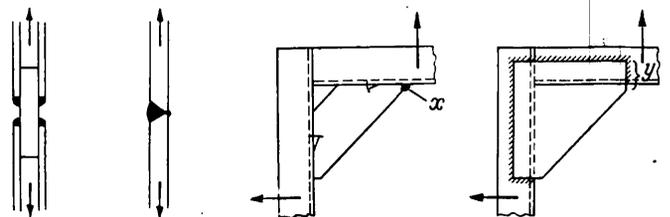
a. Versuchsstab mit Kehlnahtschweißung } Versuche von Prof. O. Graf.
